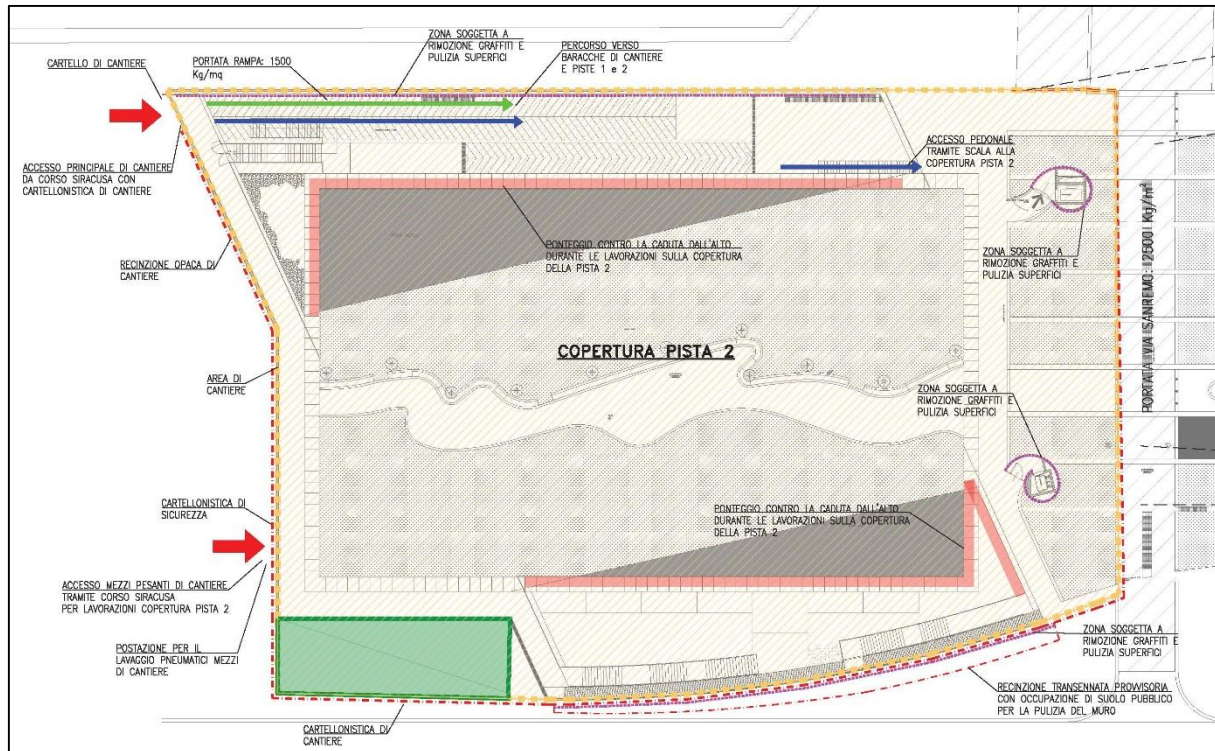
Layout di cantiere relativo alle lavorazioni sulla copertura della Pista 2.
